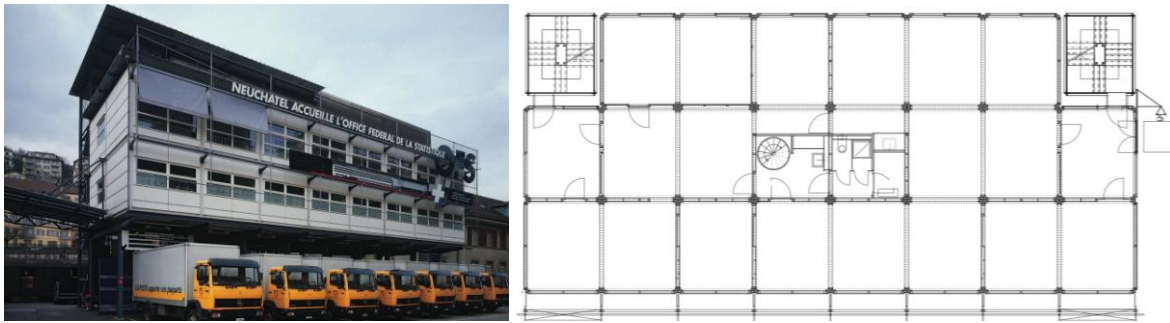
Baustelleninfrastruktur Modular-T, Neuenburg Bild und Grundriss 1. Obergeschoss / Bauart Architekten und Planer AG
